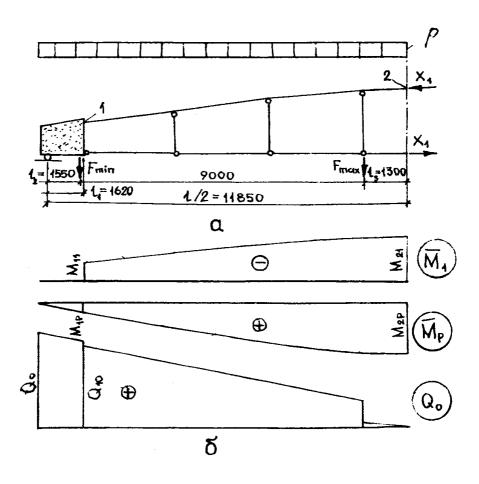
К примеру расчета фермы-диафрагмы а-расчетная схема и нагрузки:0-единичная: грузовые эпюры моментов и поперечных сил в верхием поясе
